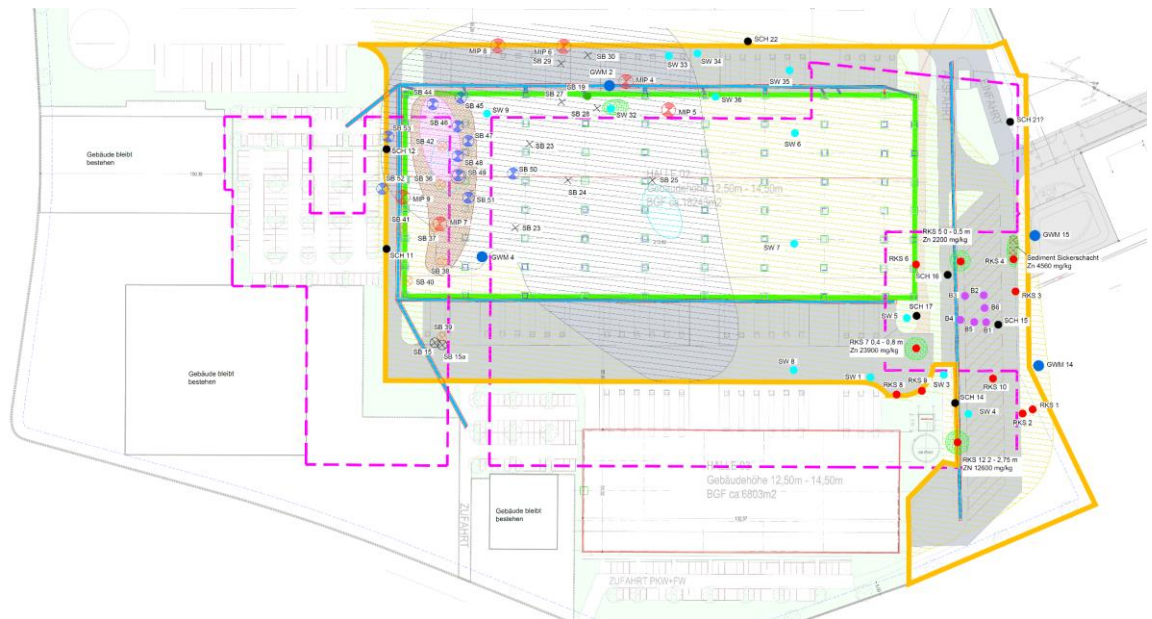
Bauabschnitt 2a; Neubau Halle 2
